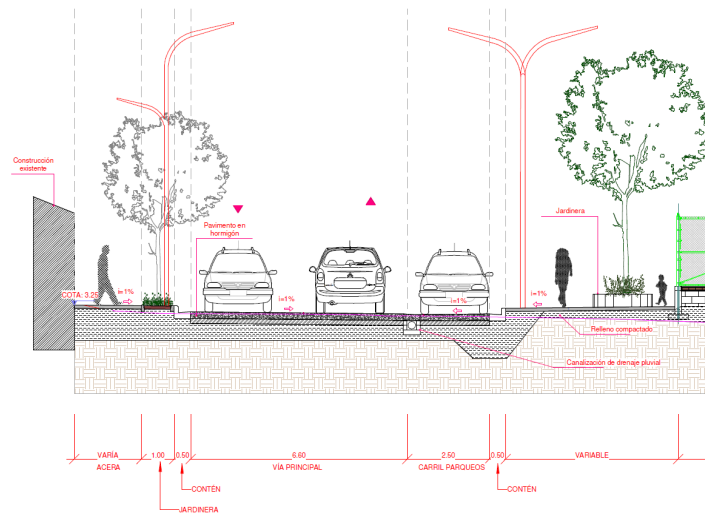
Vista en planta y sección de vía principal con franja de parqueos. Fuente: URBE, ocyubre 2025
